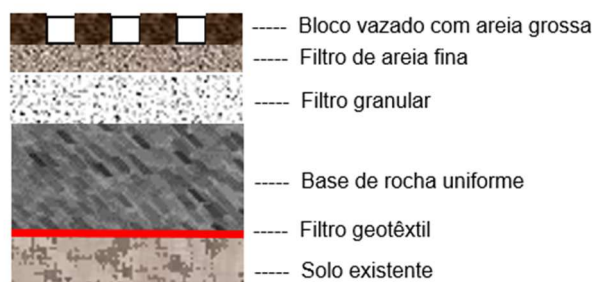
Estrutura de pavimento (revestimento em blocos de betão com orifícios verticais) (A. Costa, 2010).
